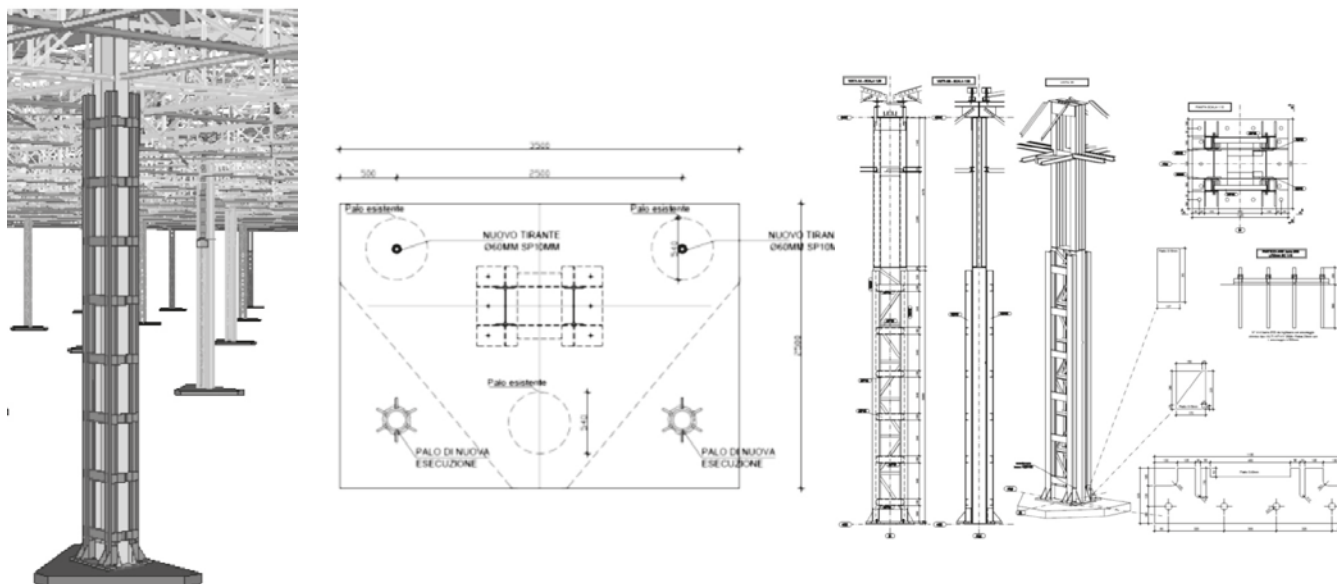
Da sinistra: Rinforzi colonna, piastra di base e fondazione, dettagli ancoraggi.
